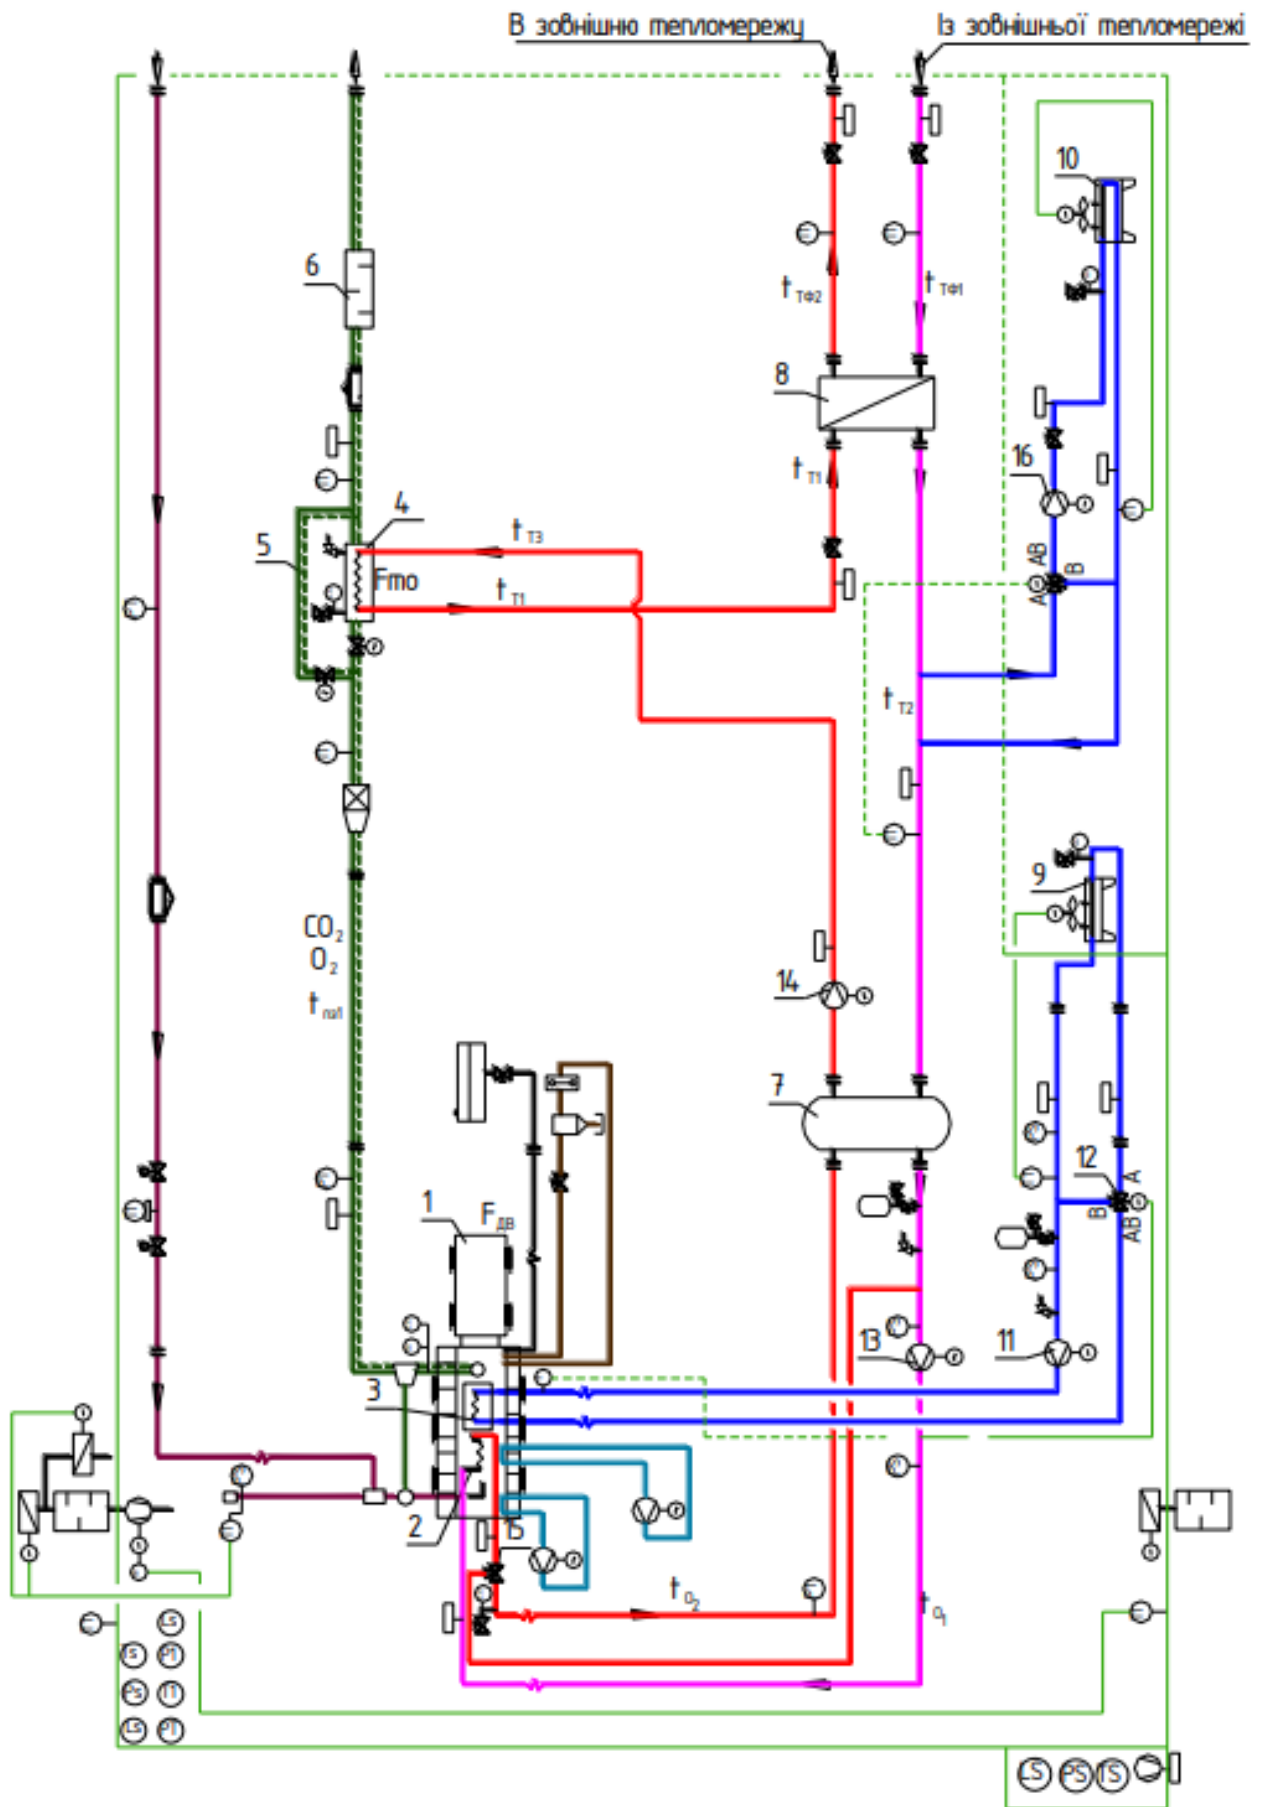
Принципова схема роботи когенераційної установки Avus 800c
